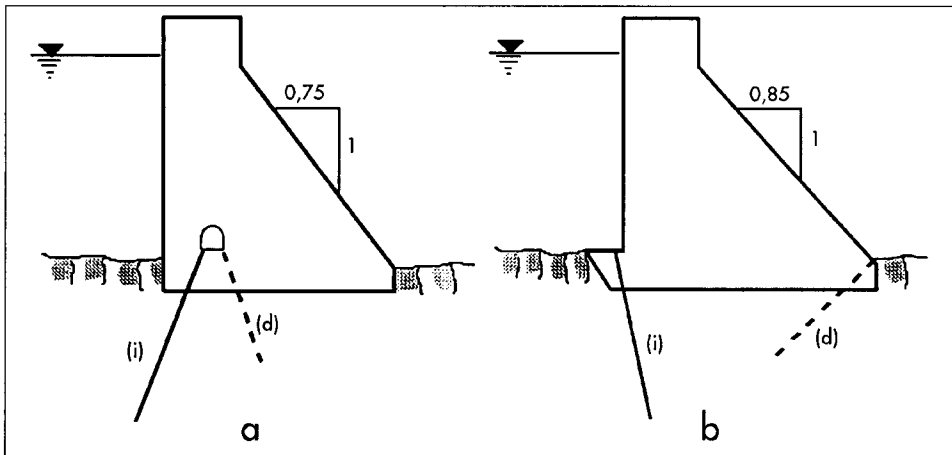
Implantation du rideau d'injection (i) et du voile de drainage (d) : a - avec galerie ; b - sans galerie
